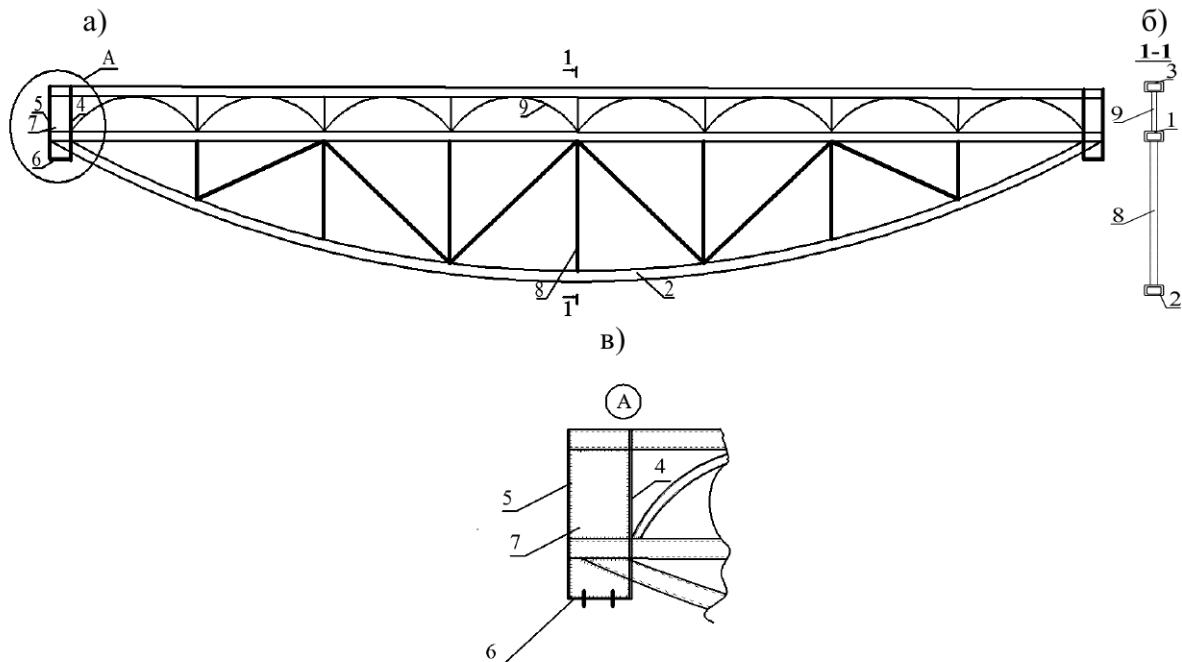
Комбінована металева конструкція ферми: а – загальний вигляд; б – розріз 1-1; в – вузол «А»
